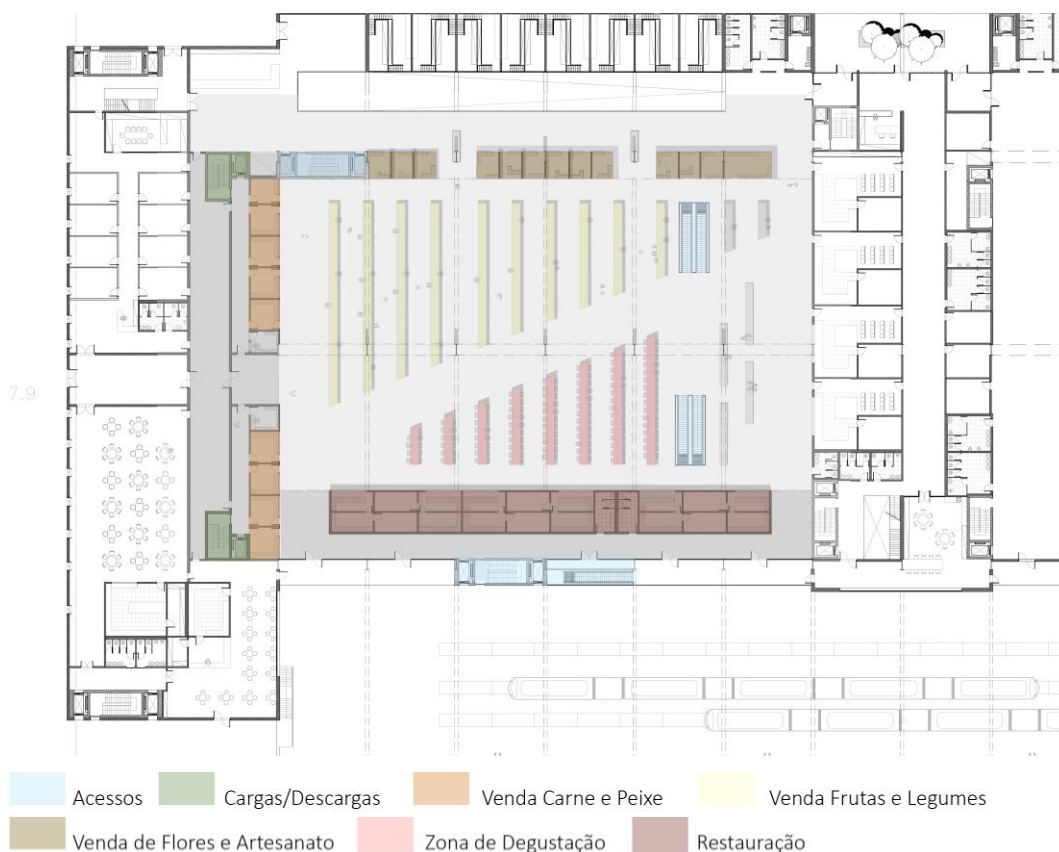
Imagem da Planta Piso 1 – Mercado, Fonte: Realizado pelos autores.
